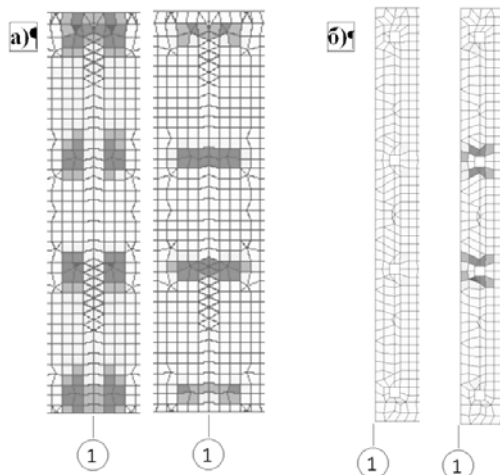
Нижнее армирование ростверка в продольном и в поперечном направлениях. а - двухсекционное здание на сплошном ростверке; б - отдельная секция здания
